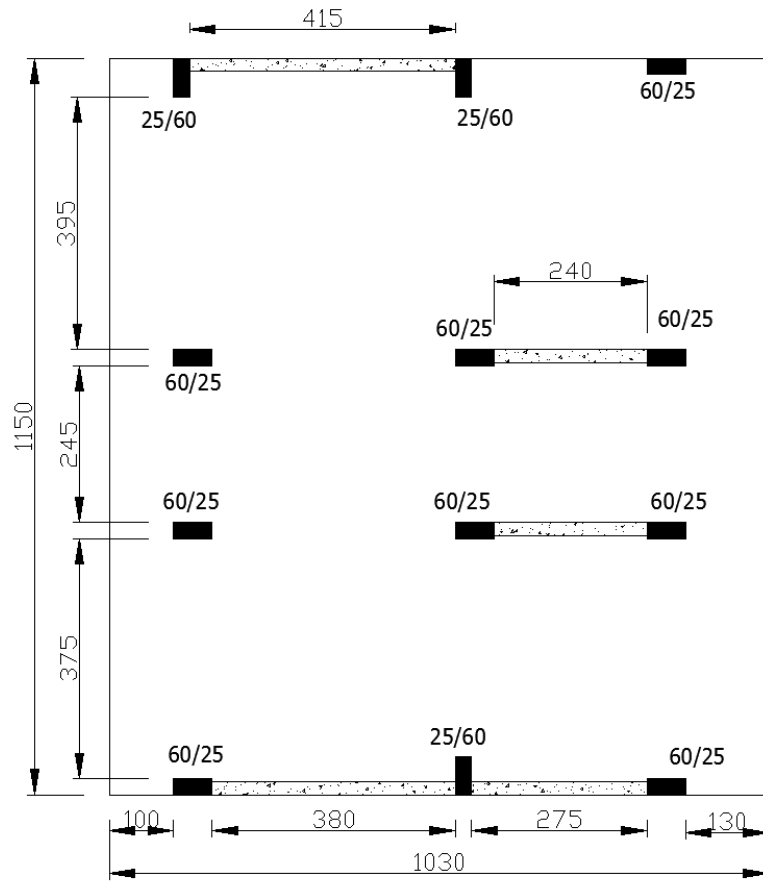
BNG-6-3-1 binasının kat planı [SERU Structural Engineering Research Unit, 2011]
